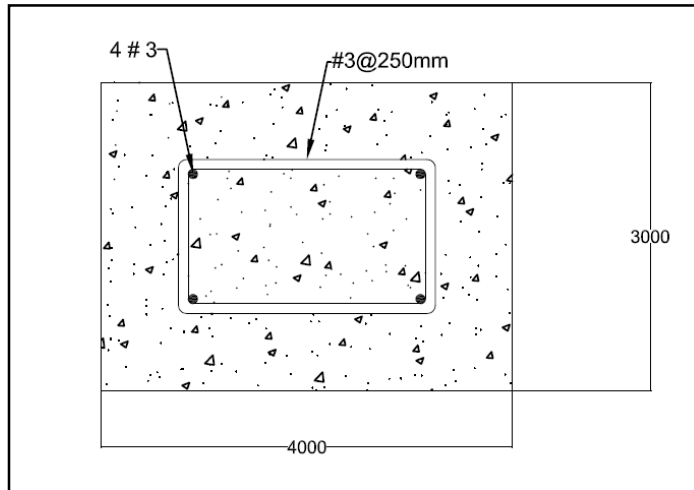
Detalle de la placa de muros de retención con suelo reforzado 2m
